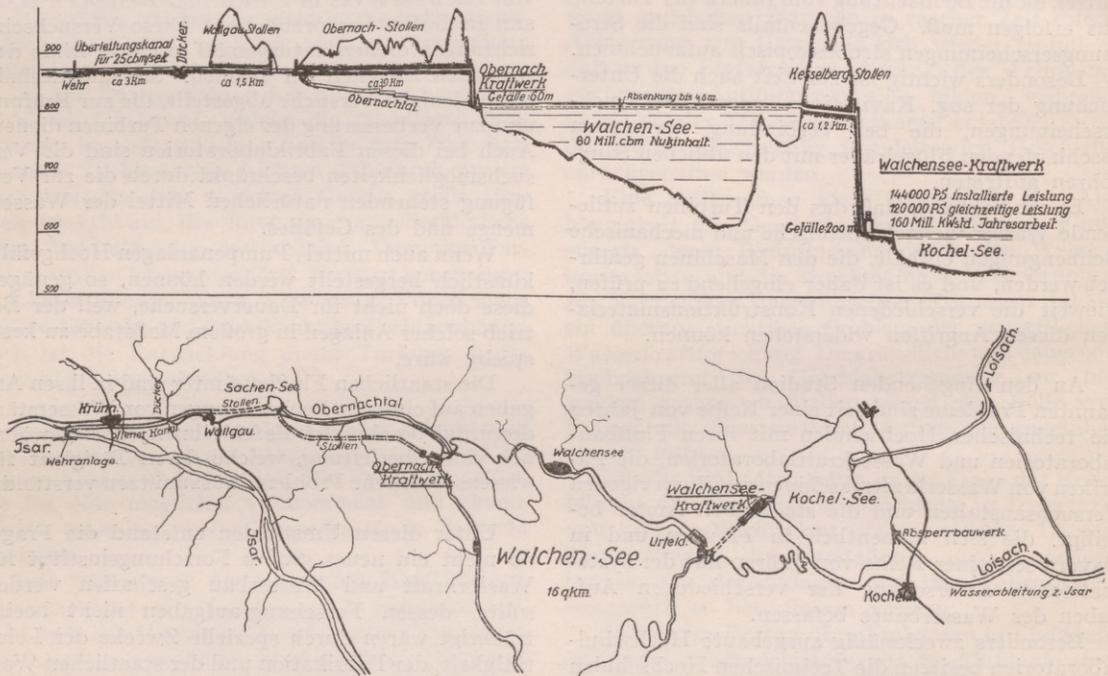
Übersichtsplan mit Höhenprofil des Walchenseewerkes.
